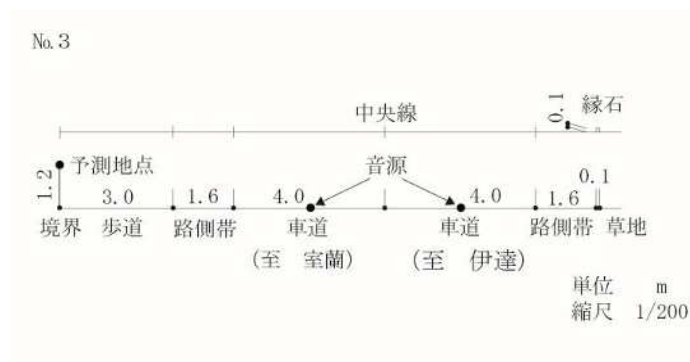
(1) 予測対象道路の断面図 (No. 3)
